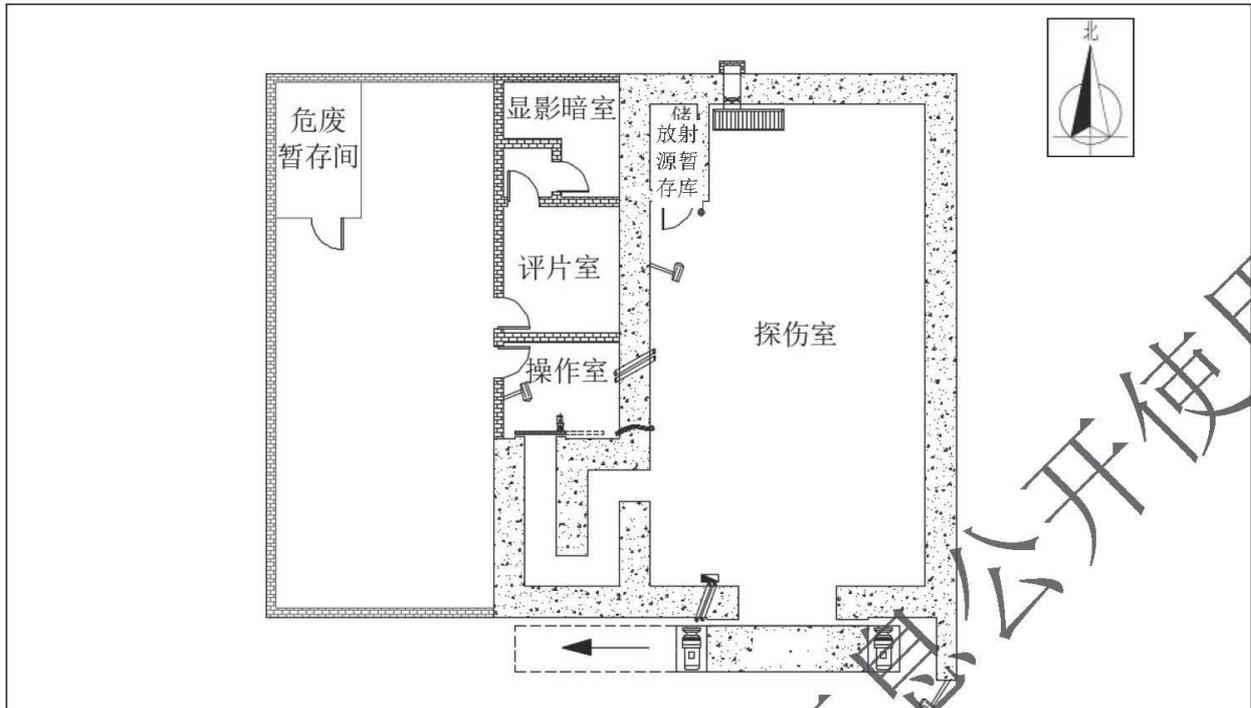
本项目探伤室、放射源暂存库平面布置示意图
